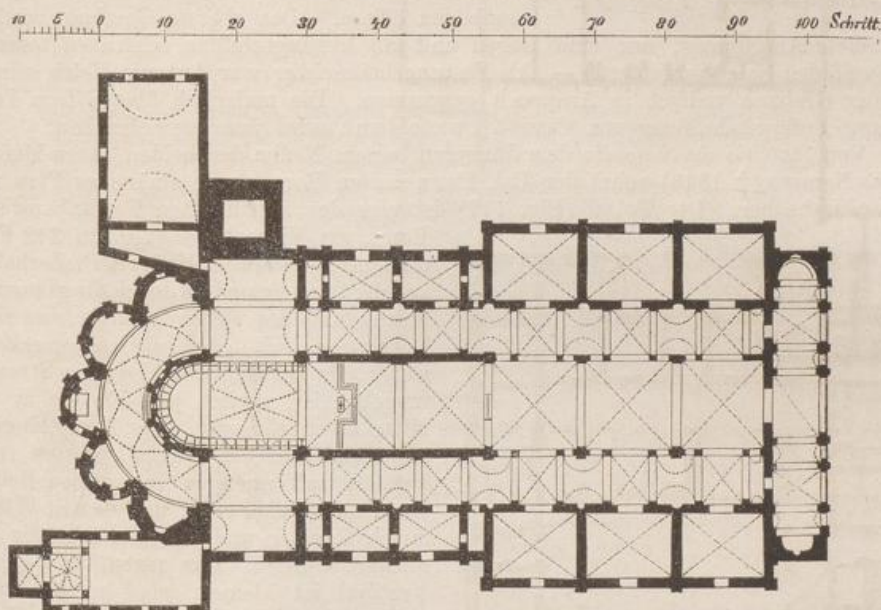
Grundriss der Kirche in S. Benedetto. (M. Lohde.)
